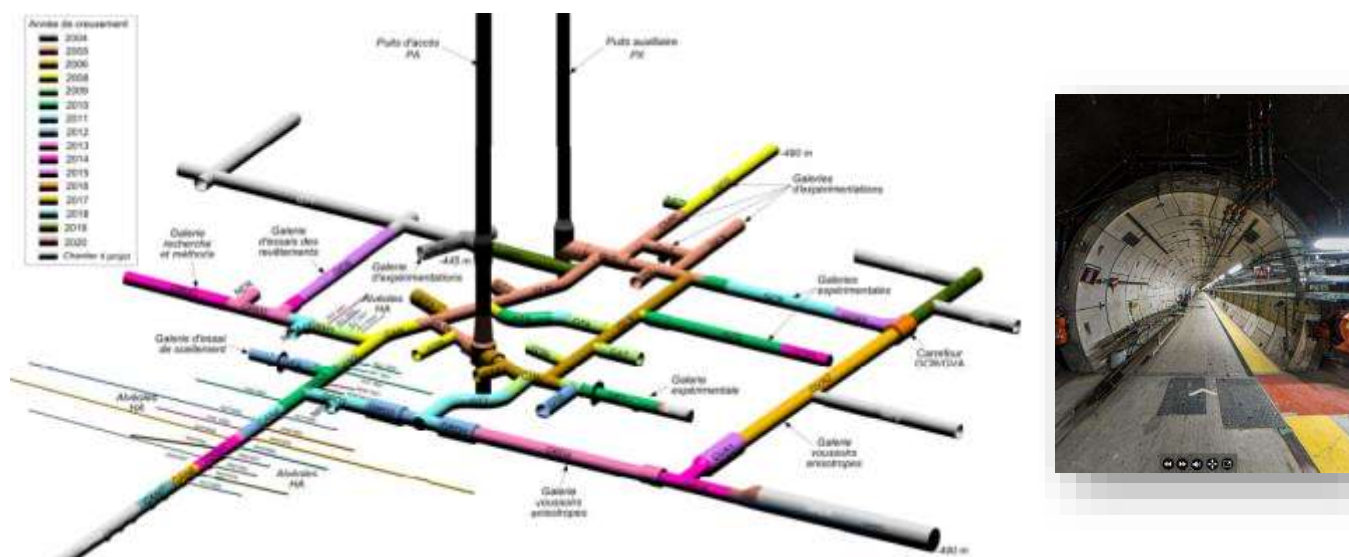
Installations souterraines et vue d'une galerie du laboratoire et (source : ANDRA)
